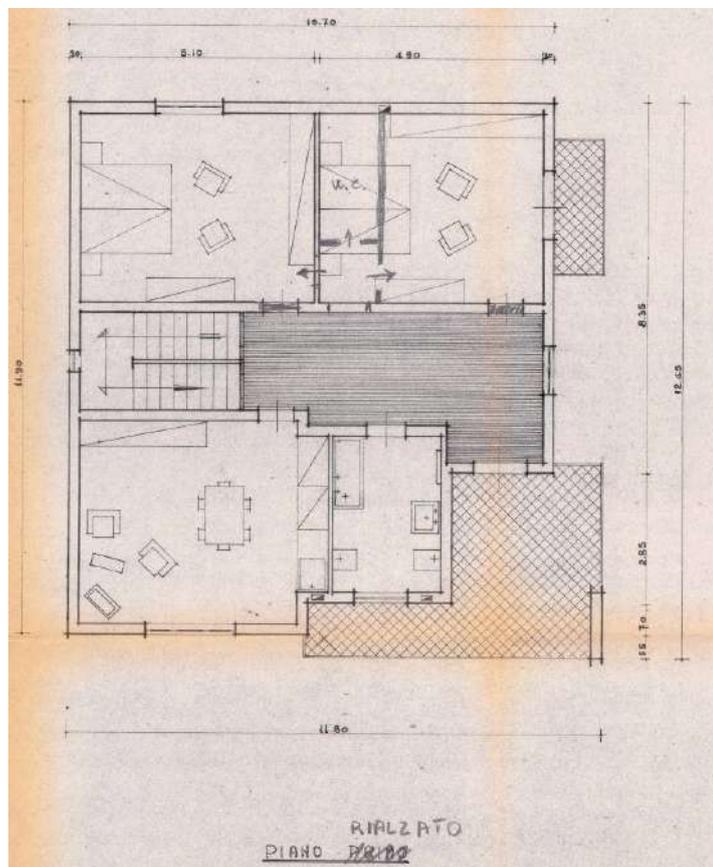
Licenza di Costruzione n. 1289 del 04.03.1968 - pianta piano primo (erroneamente chiamato piano rialzato)
